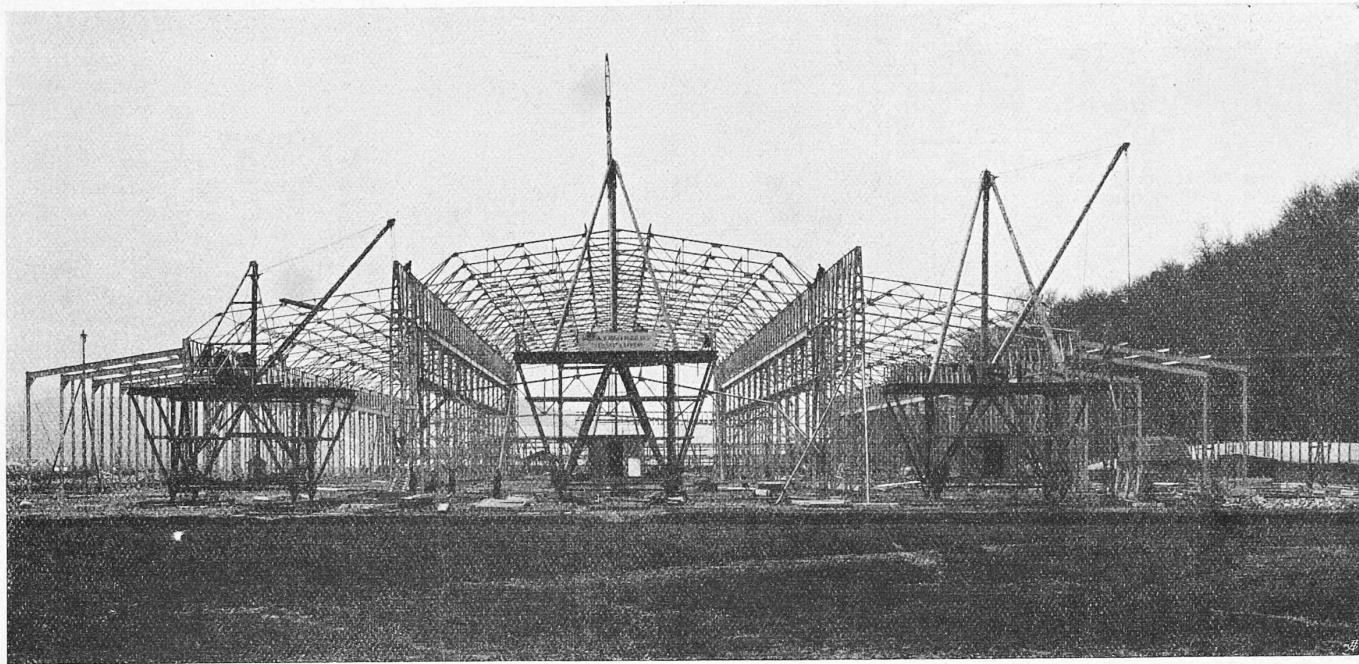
Stirnansicht der Halle während der Aufstellung mit den Montagekranen.
